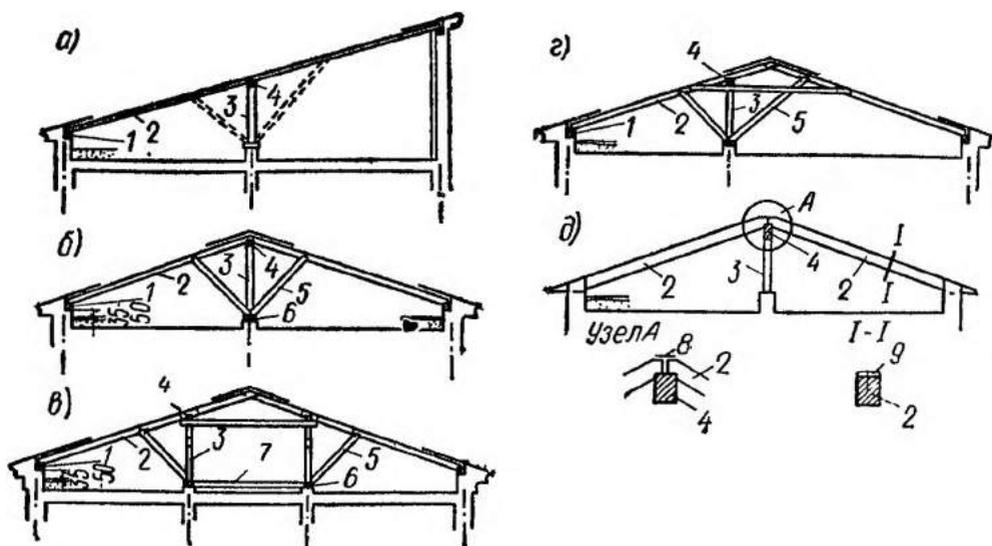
Наклонные стропила (деревянные стропила из бревен и брусьев)
